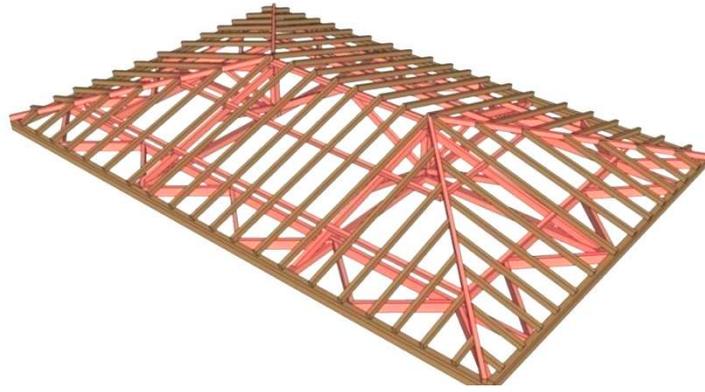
Contreventement d'une toiture à 4 versants par poutres au vent horizontales dans le plan des entrails.
